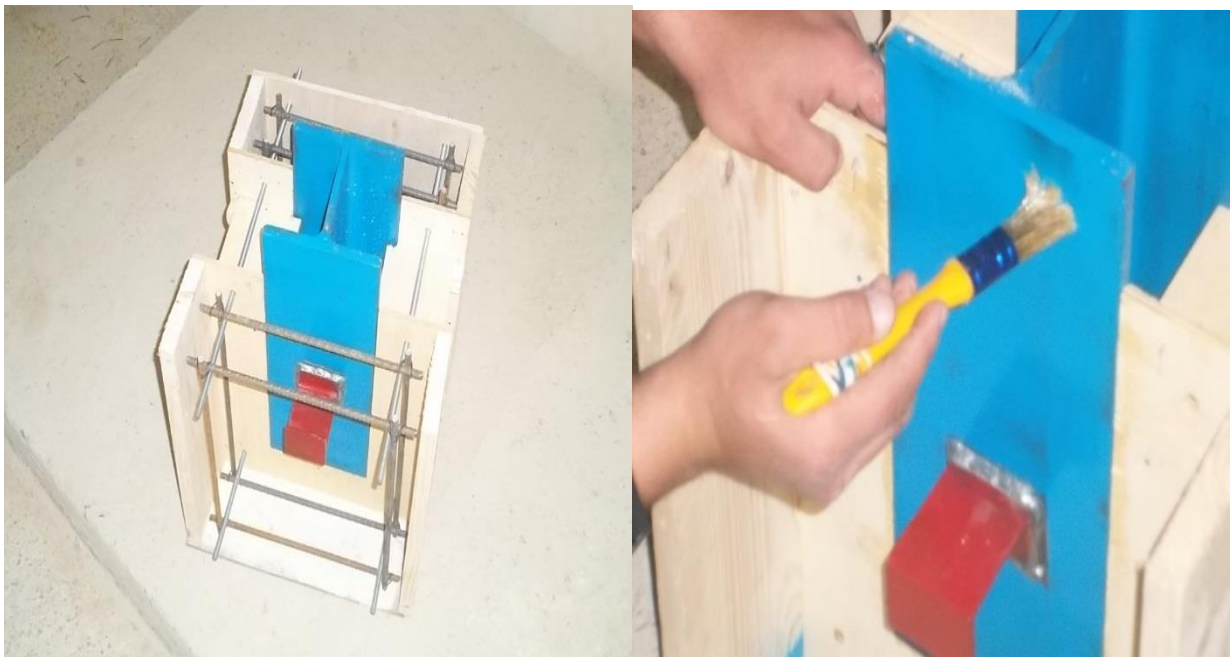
Huilage des semelles et disposition des barres d'armature.
